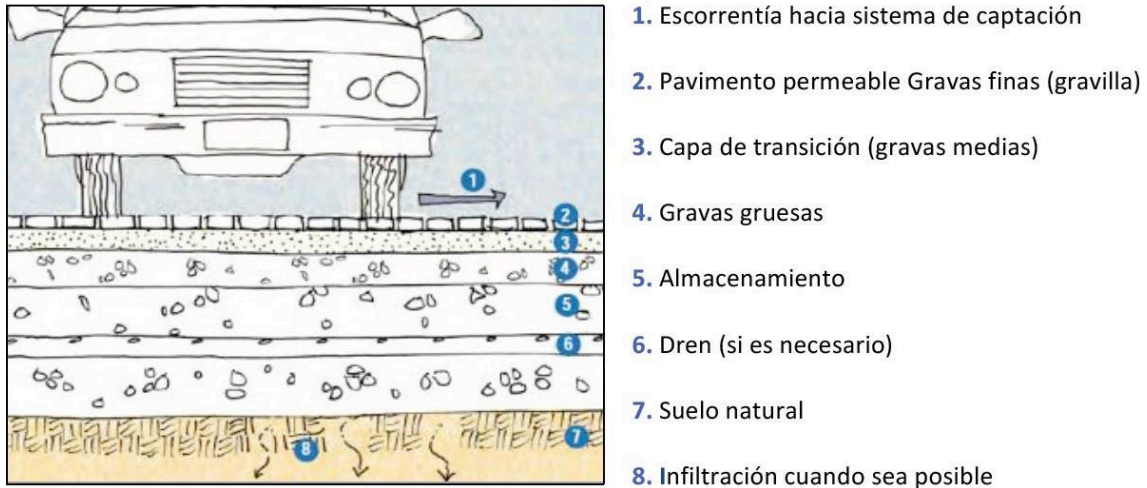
Esquema de un pavimento permeable. Fuente: SFPUC, (2010). Stormwater Design Guidelines.
